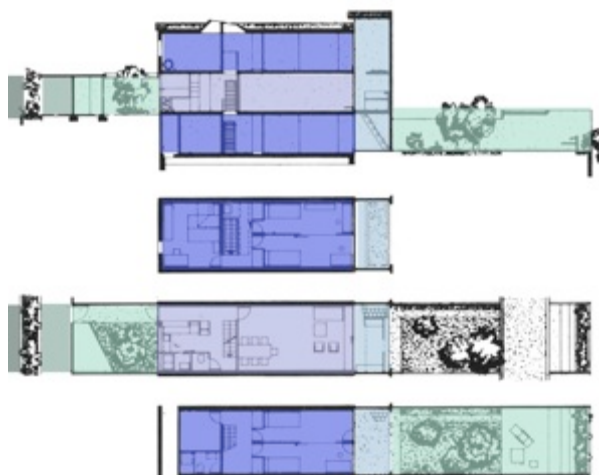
Habitação Tipo 12. [Corte e plantas de piso inferior, piso intermédio e piso superior (de cima para baixo)].
